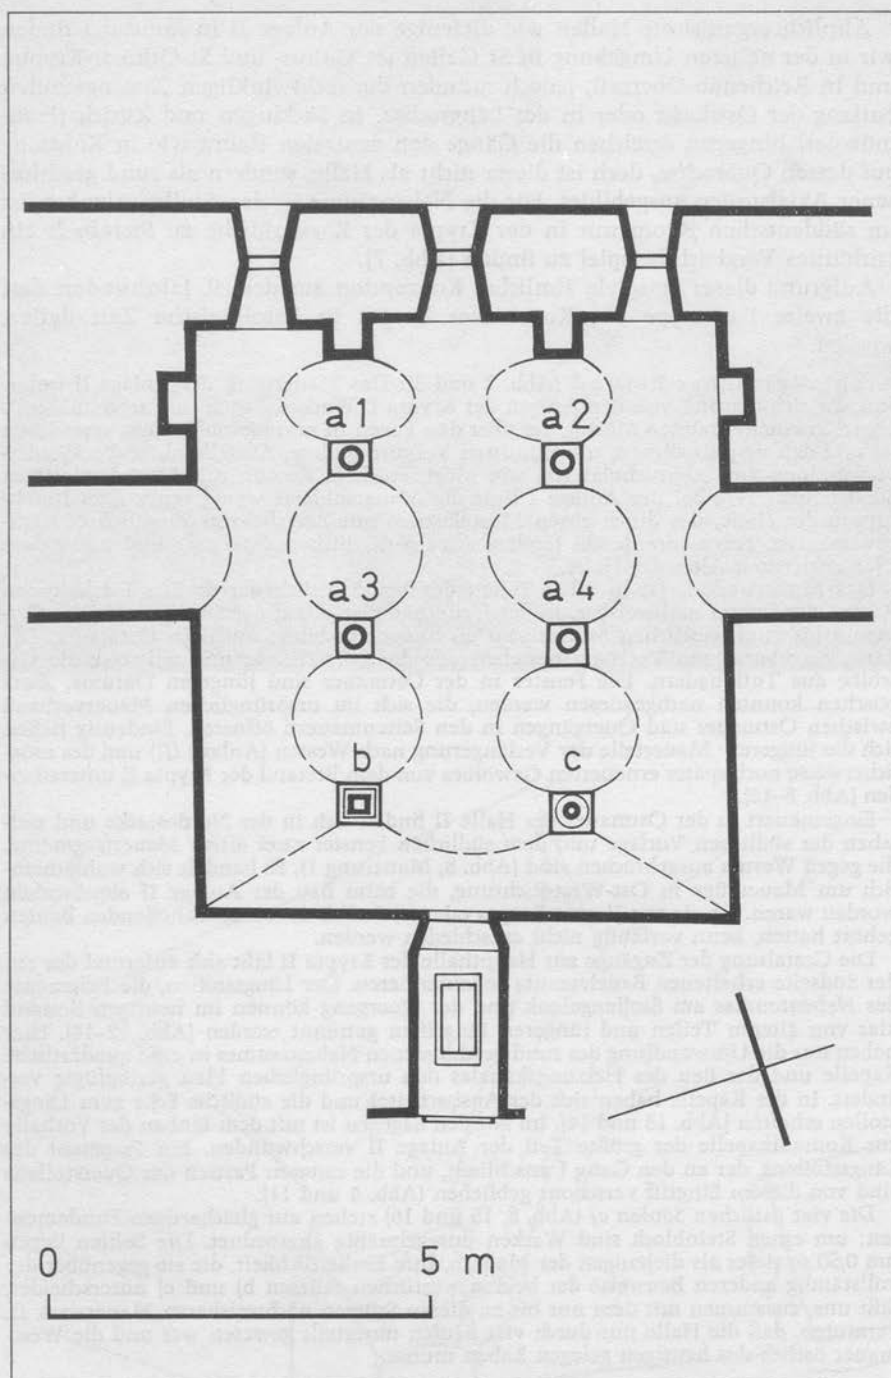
Grundriß der Haupthalle mit Gewölbem, Maßstab 1:100.
